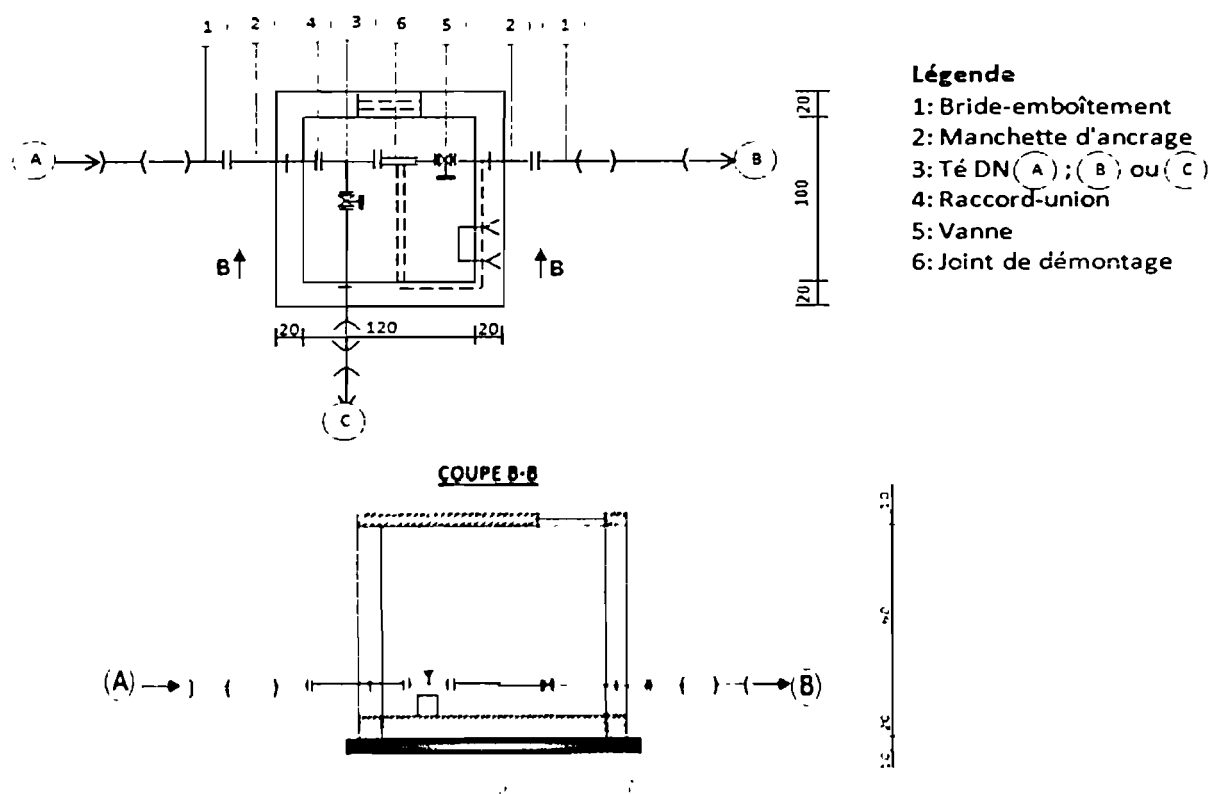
vue en plan et coupe de chambre de vannes et de sectionnement
